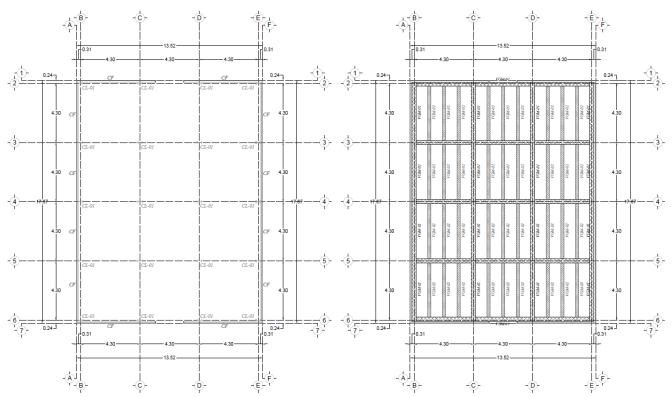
Planos estructurales de columnas y trabes respectivamente.
